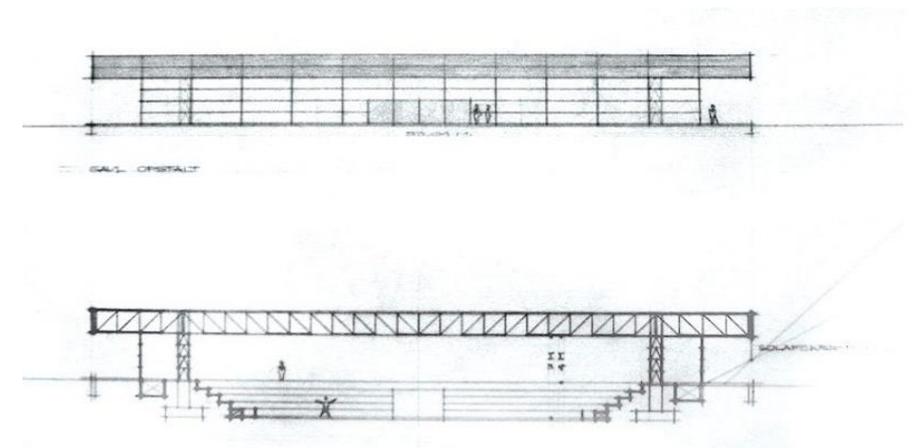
Alzado y sección del pabellón de Landskrona sports hall
